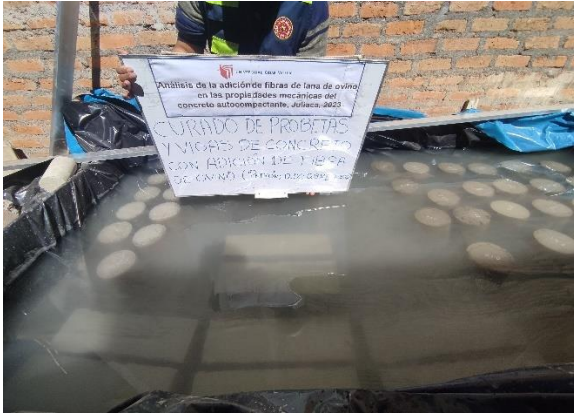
REALIZANDO LAS PROBETAS Y VIGAS DE LOS DISEÑOS
